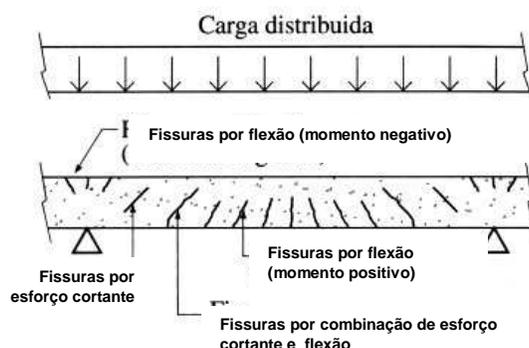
Representação esquemática das patologias observadas em vigas de concreto armado com fissuração devido ao esforço cortante e flexão (HELENE, 2003).
